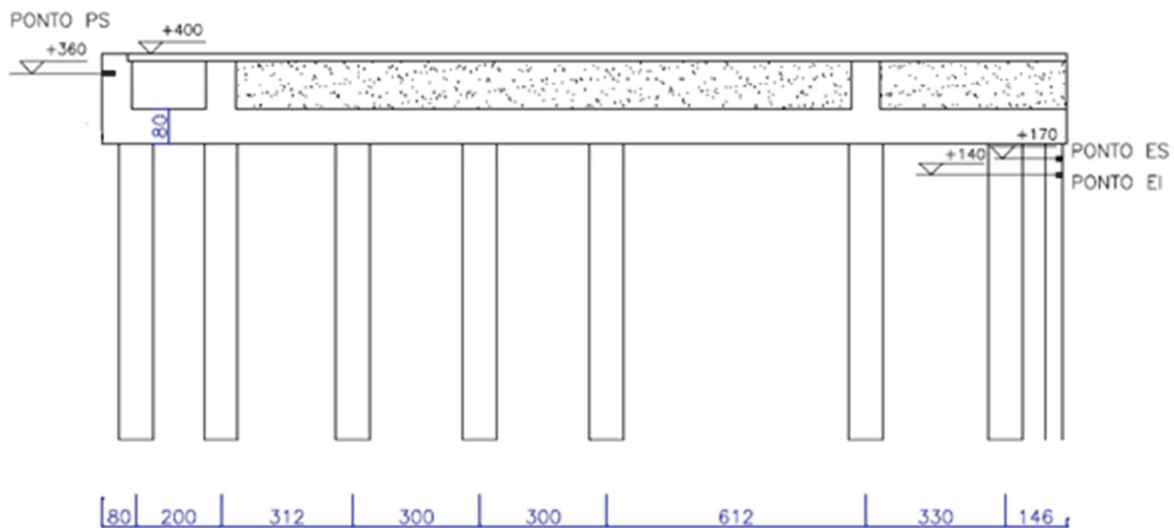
Perfil da estrutura do cais e localização dos pontos de coleta (Adaptado: GUIMARÃES, 2000). PS – viga do paramento ponto superior; EI – estaca prancha ponto inferior; ES – estaca prancha ponto superior.
